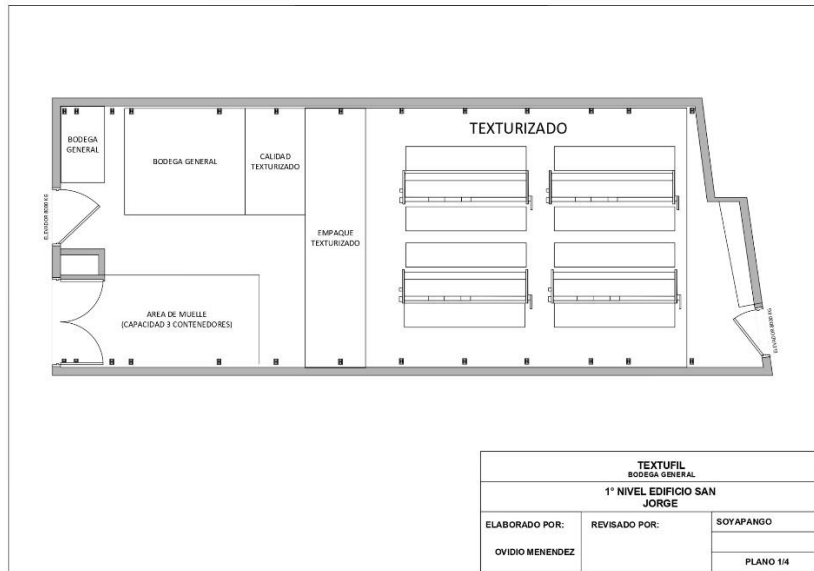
Distribución en Planta Nivel 1 edificio San Jorge
